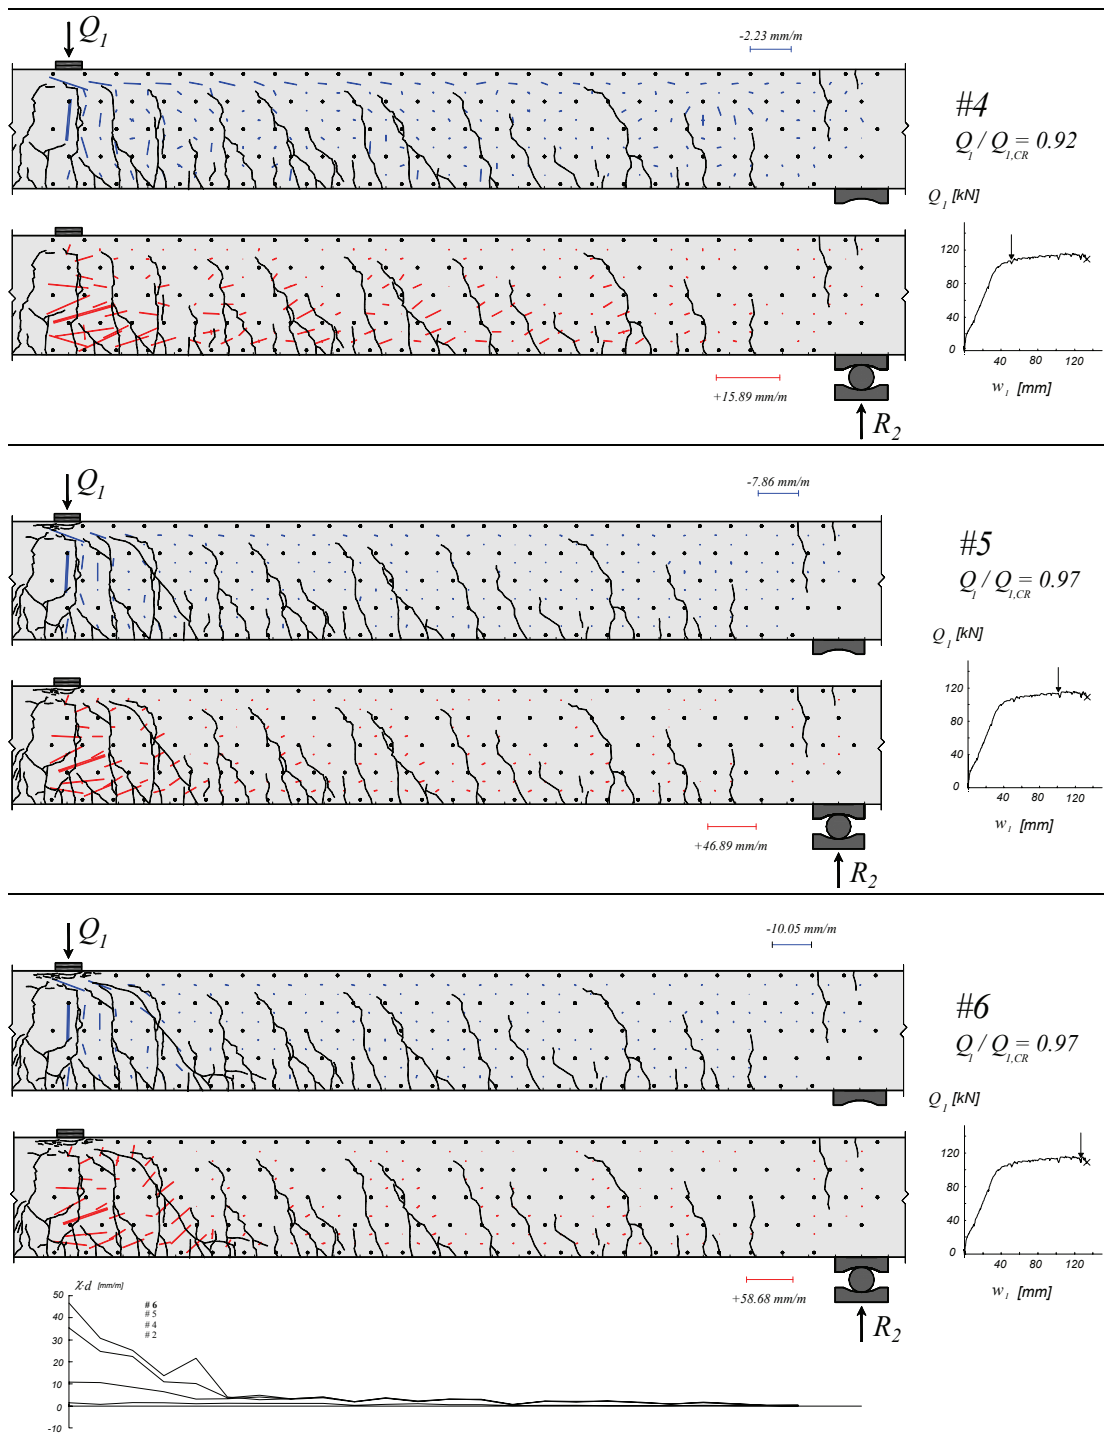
Poutre SR8: déformations principales, fissuration et courbures
